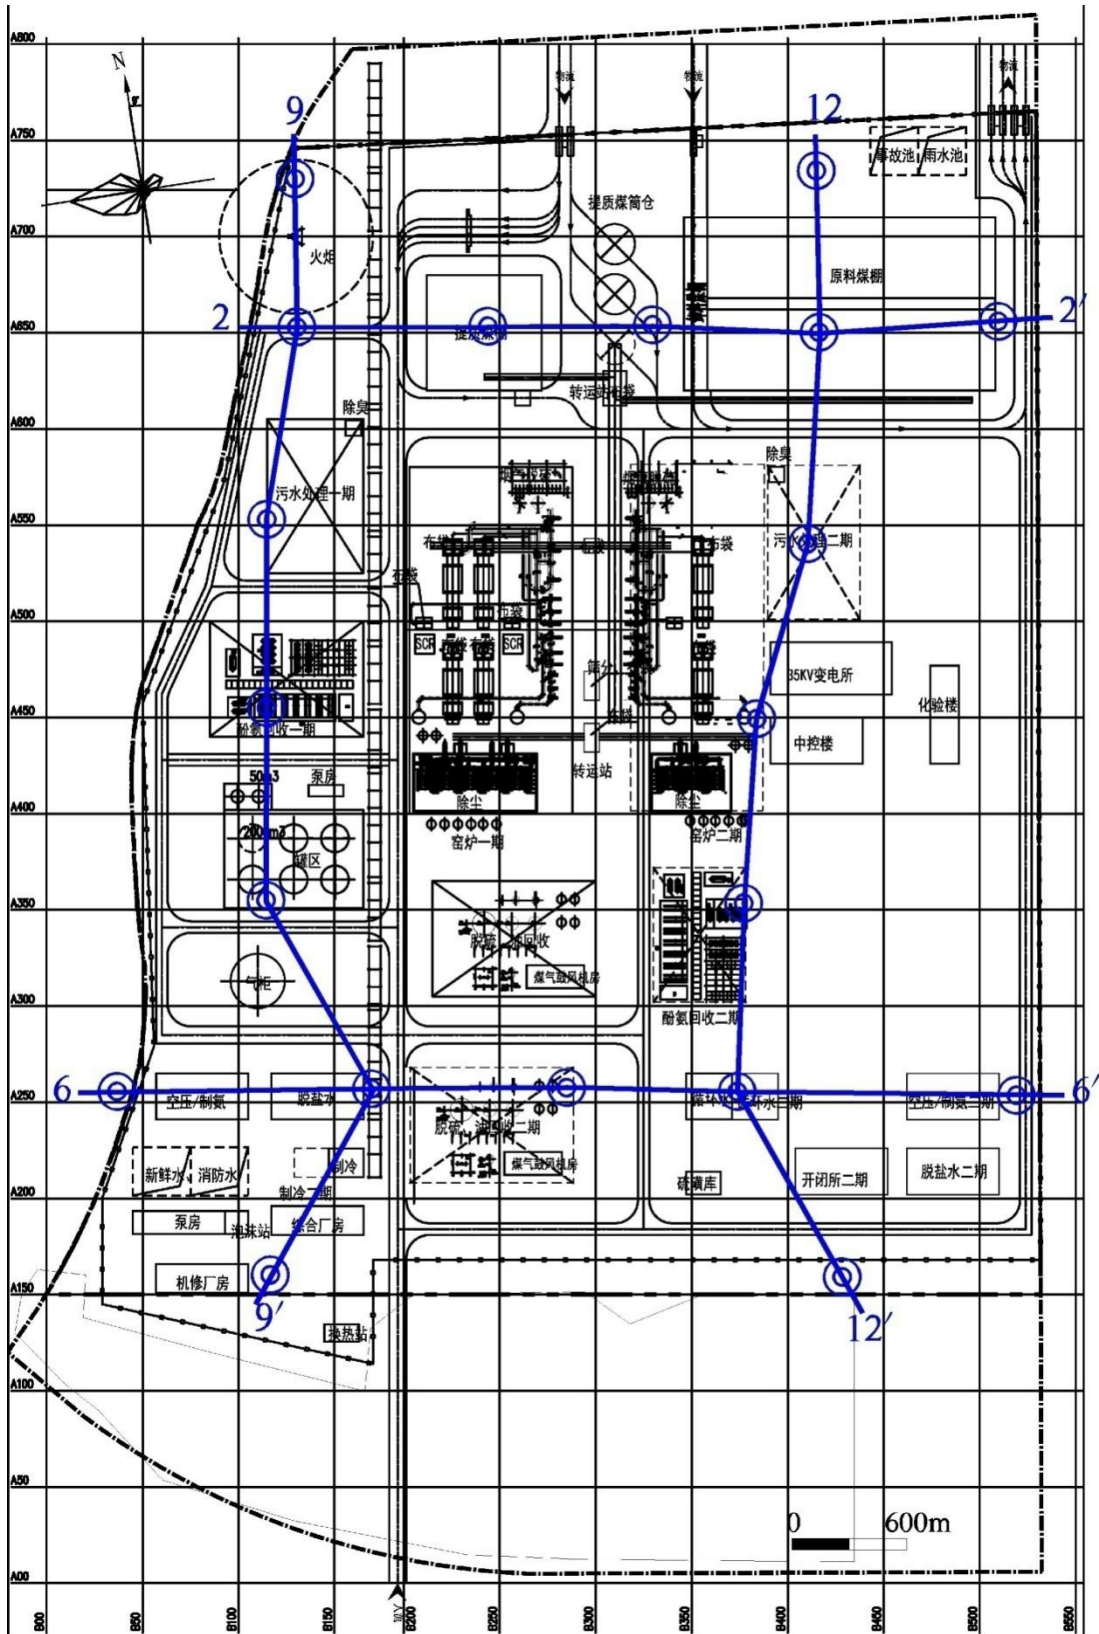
山西远尔州绿色能源科技有限公司厂区钻孔平面布置图
